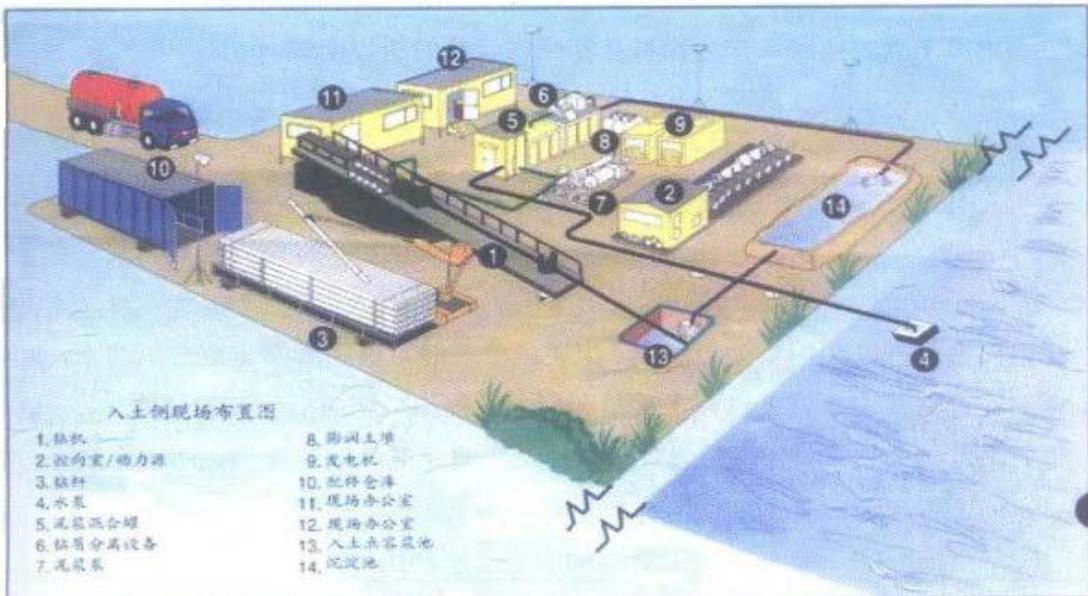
定向钻施工场地平面布置图（入土侧）
